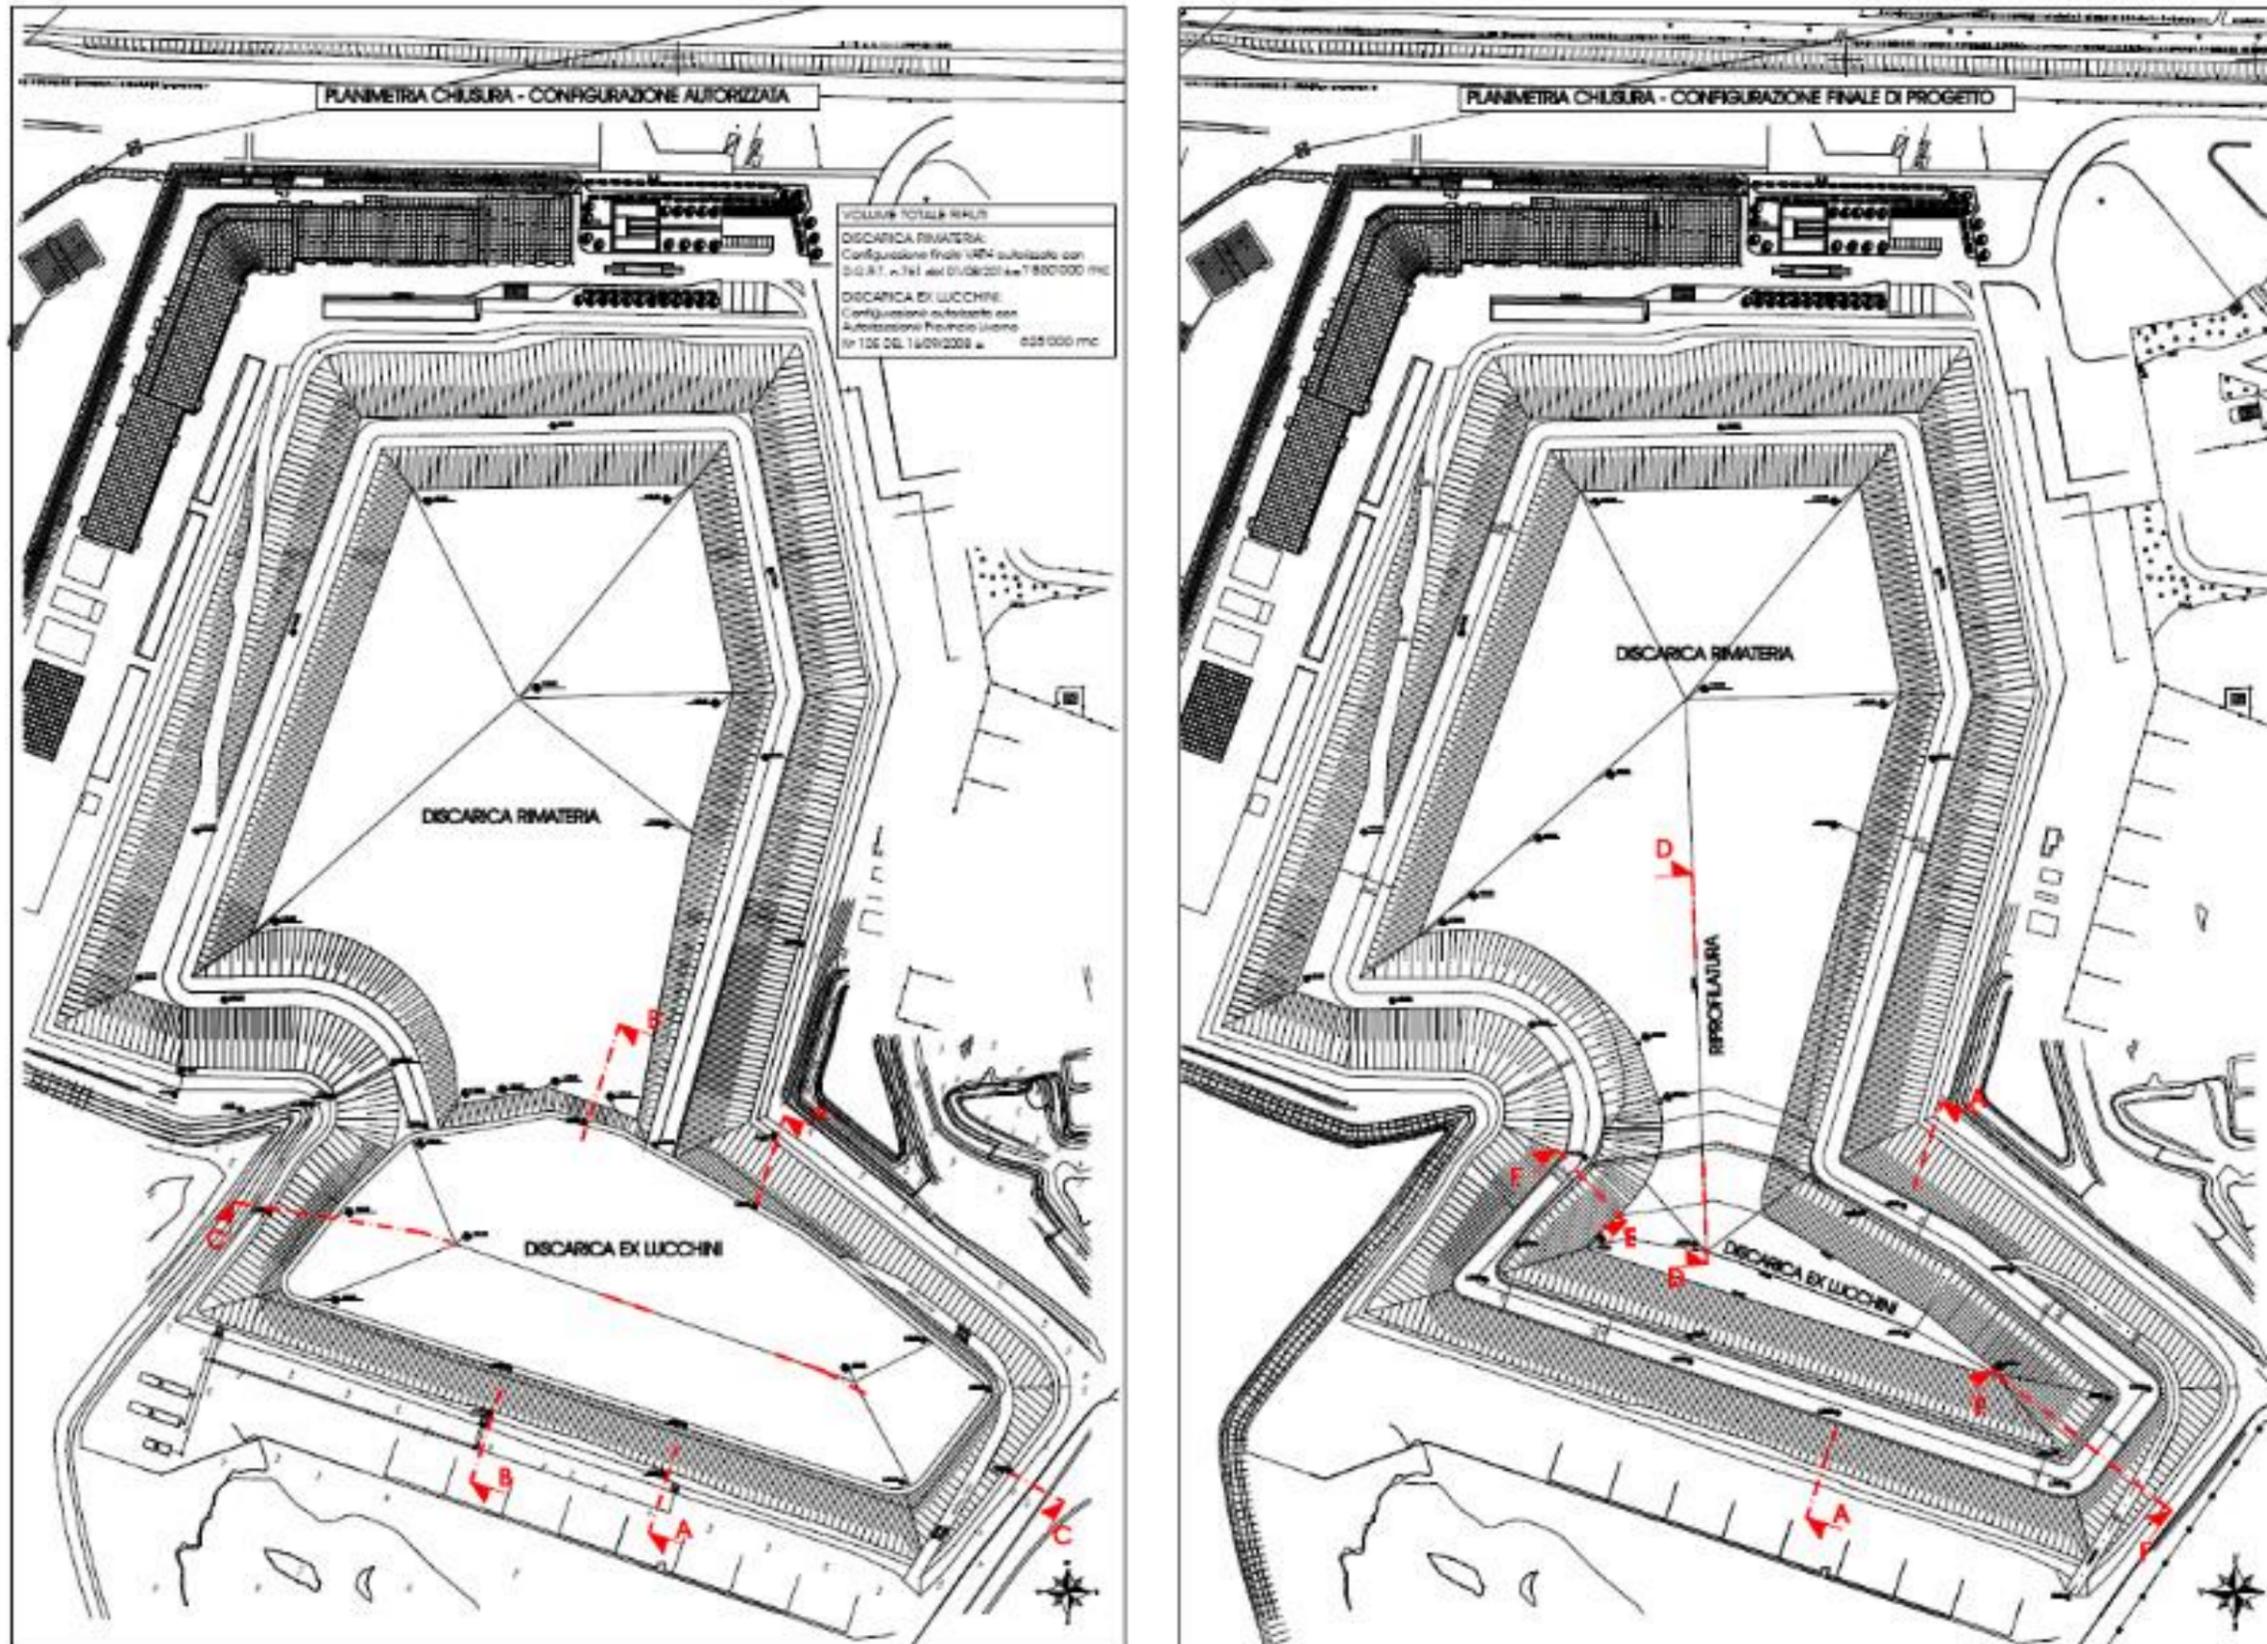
Planimetria stato autorizzato e planimetria stato di progetto (estratto dalle tavv.di progetto TAV.1 VAR_CAP_TAV01_r2 e TAV.2 VAR_CAP_TAV02_r2)
